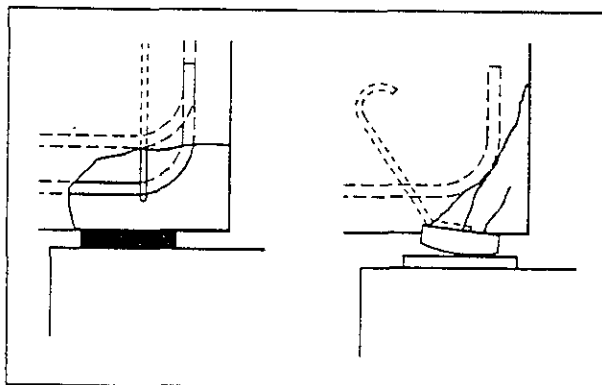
Trituración causada por apanalamientos, tipo equivocado de apoyo o fabricación pobre
